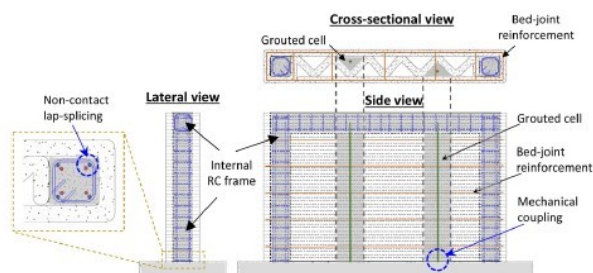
Dettagli costruttivi della parete 3DPC proposta, con elementi di confinamento in calcestruzzo armato (Aghajani Delavar et al. 2024).
